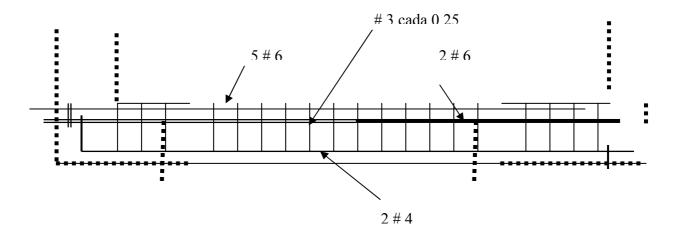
Detalles de la viga de enlace del ejemplo 12.4
